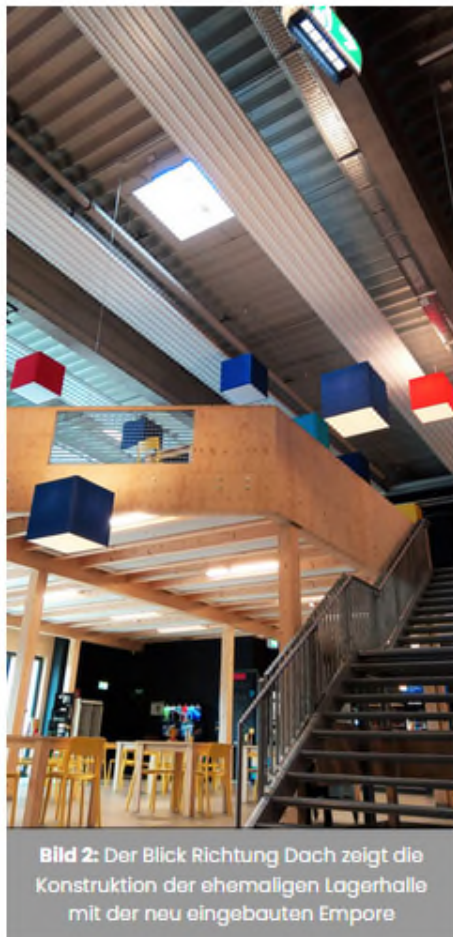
Der Blick Richtung Dach zeigt die Konstruktion der ehemaligen Lagerhalle mit der neu eingebauten Empore
